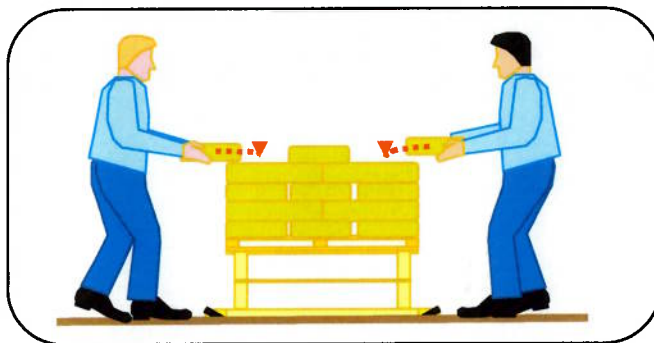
Colocação de camada intermediária sobre a plataforma elevatória.
